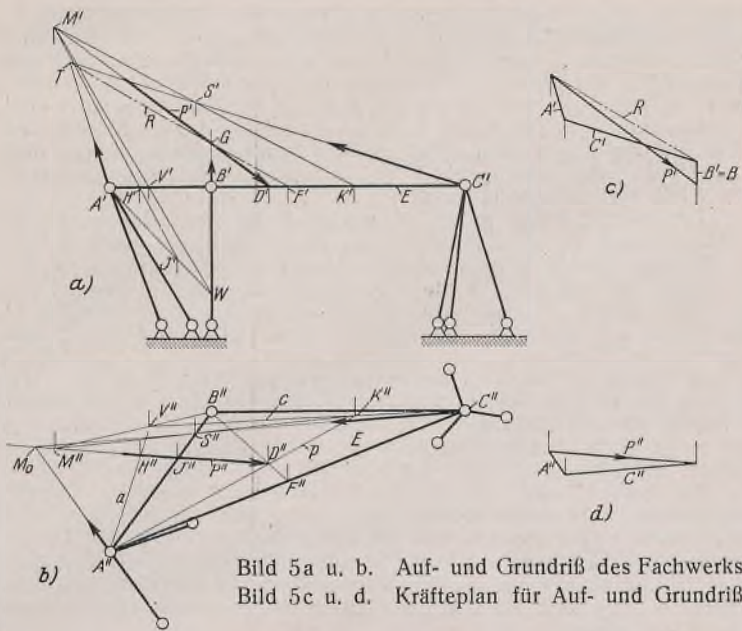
u. b. Auf- und Grundriß des Fachwerks.
